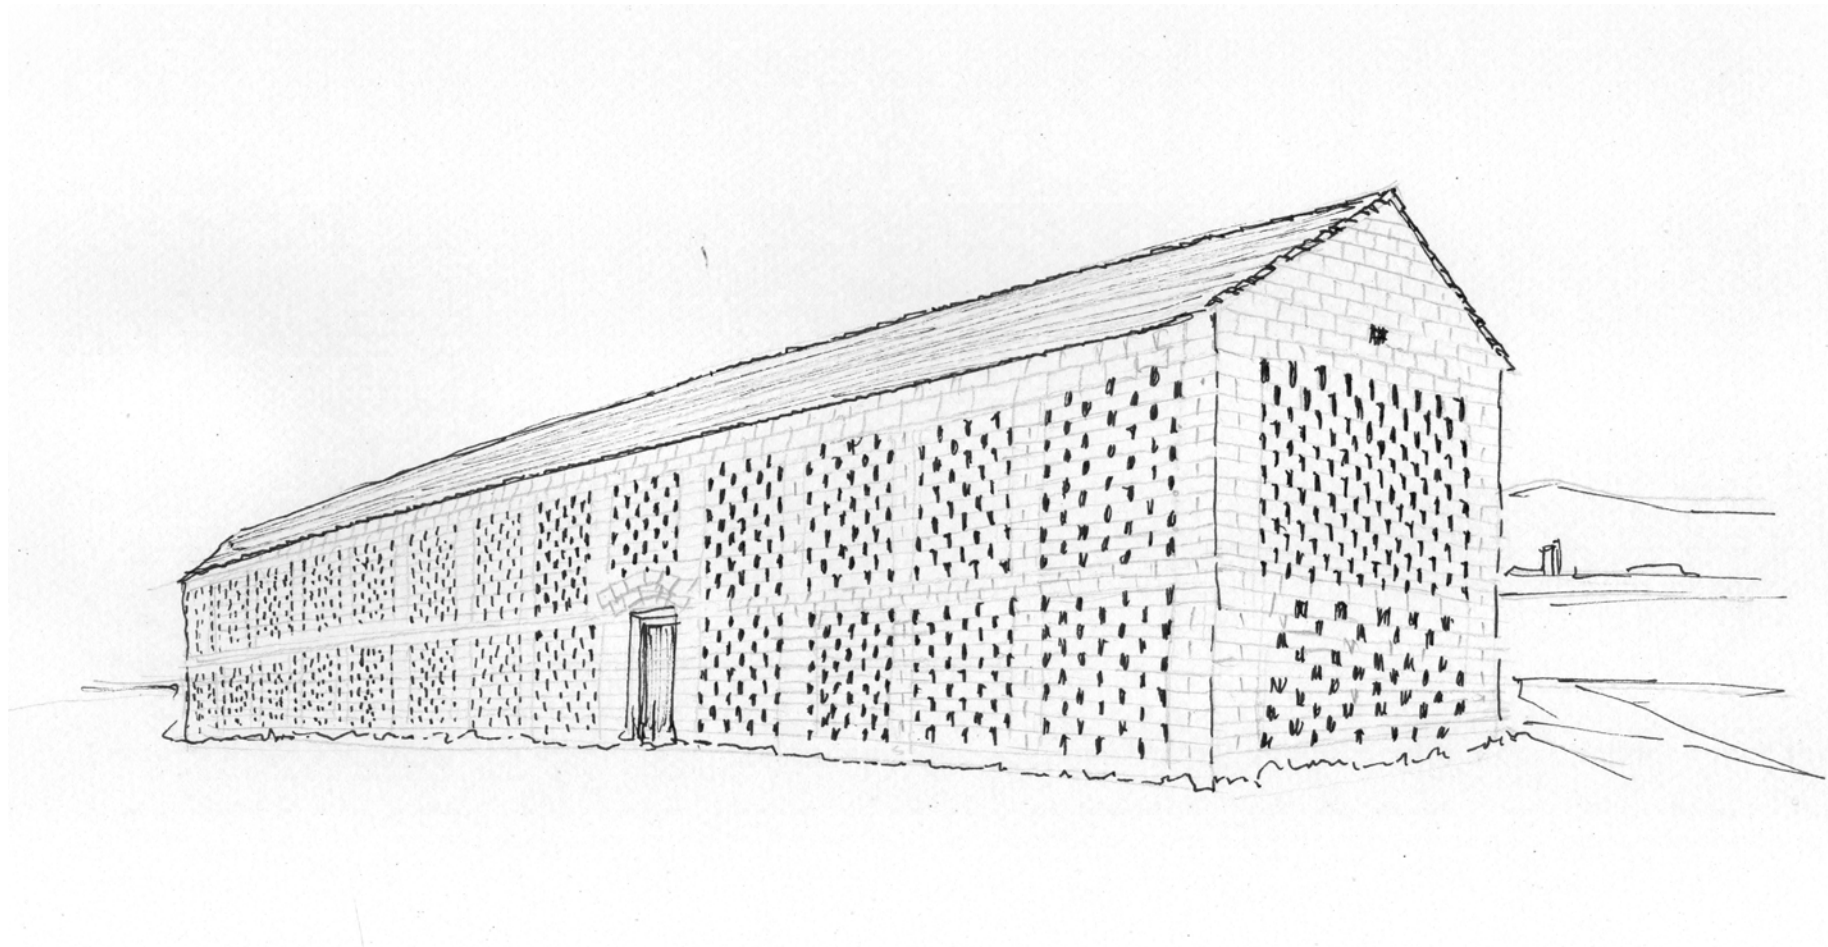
Secadero con piel de celosía de bloque de hormigón. La planta rectangular se forma debido a la sucesión de pórticos formados por una estructura mixta de pilastras, ladrillo y madera.
